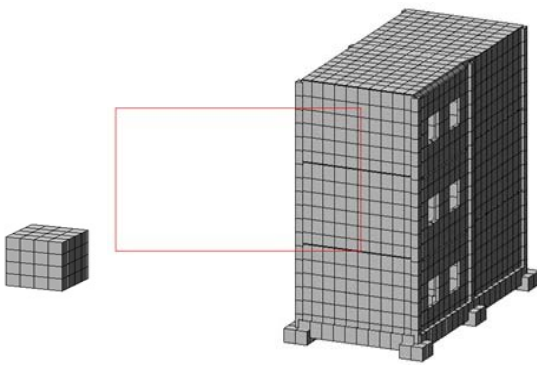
Взаимное расположение здания и железобетонного фундамента под молот
